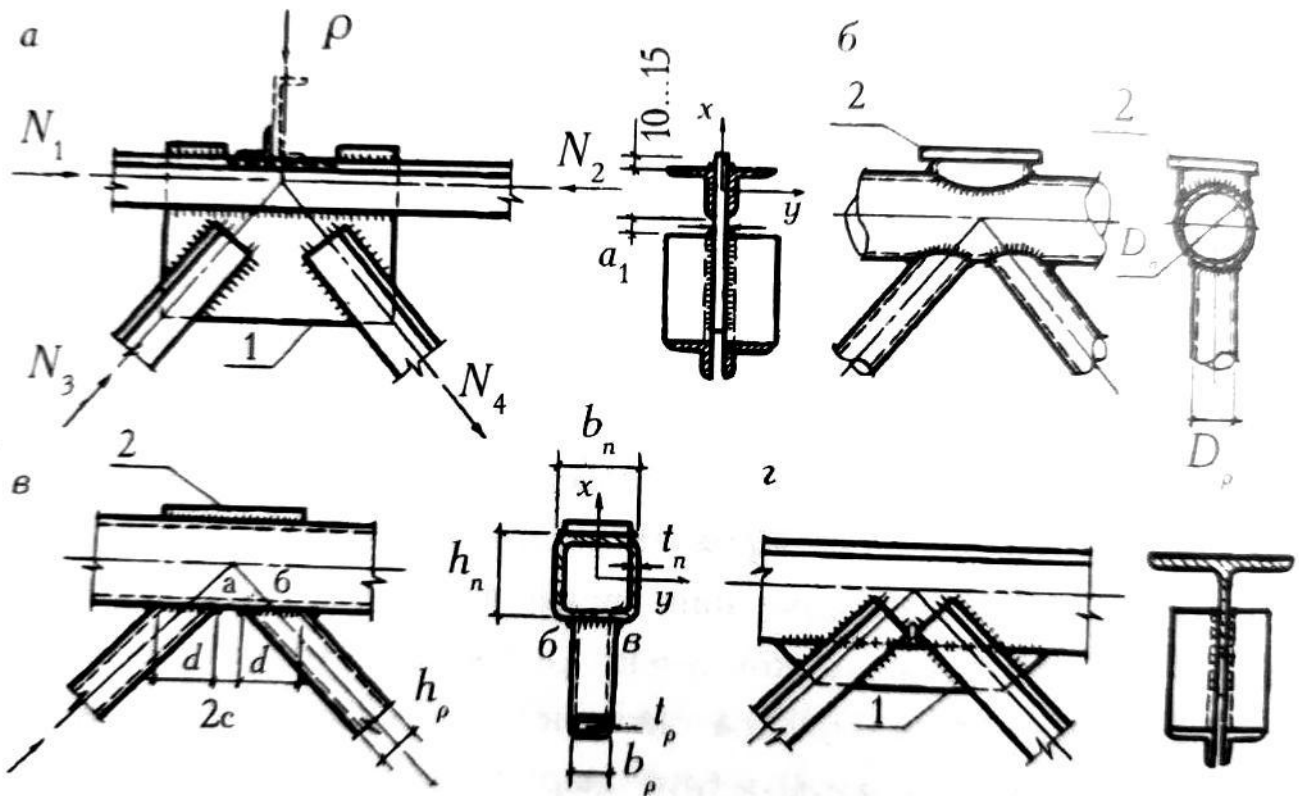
Узлы ферм: а- из парных уголков; б- из круглых труб; в- из прямоугольных труб; г- пояса из тавров, раскосы из парных уголков; 1- фасонка; 2- распределительная деталь.
